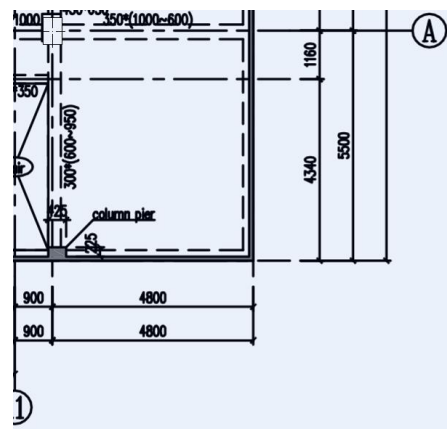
Planta de piso do painel da laje em análise (Fonte: projecto estrutural da portagem de Zintava da CRBC)
